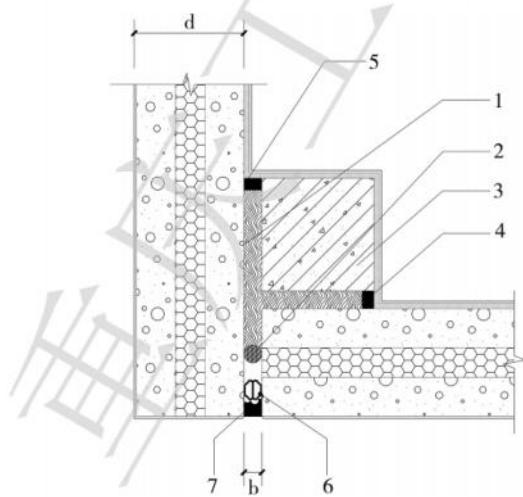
外挂墙板竖向接缝防水构造平面示意图-2
